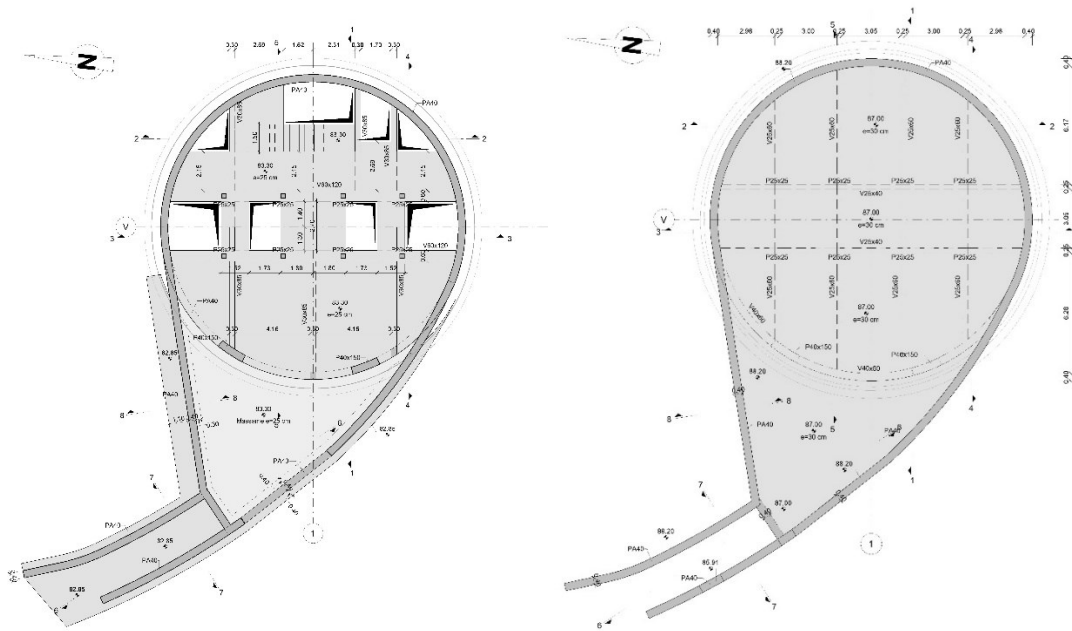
Planta da cobertura da estrutura definitiva do poço.
